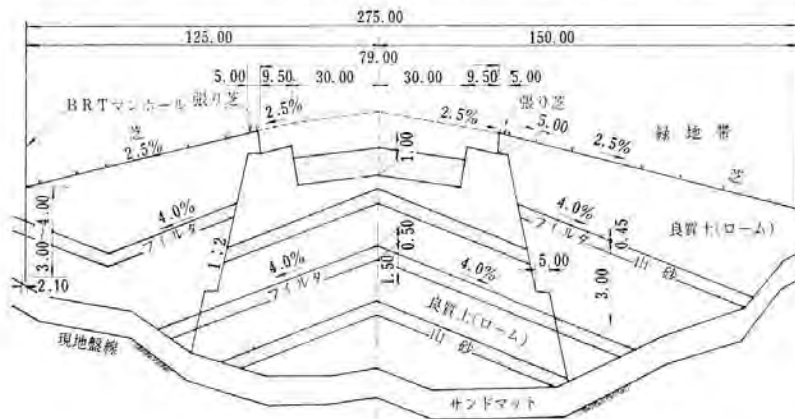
フィルタ工A滑走路標準横断面図(盛土部)
